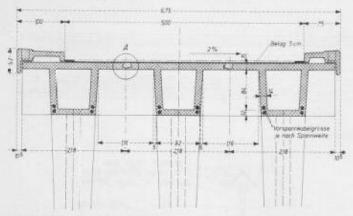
Voll vorfabrizierte Ueberführung, Querschnitt 1:80. Detail A. Fuge (Asymmetrie wegen Montage)
